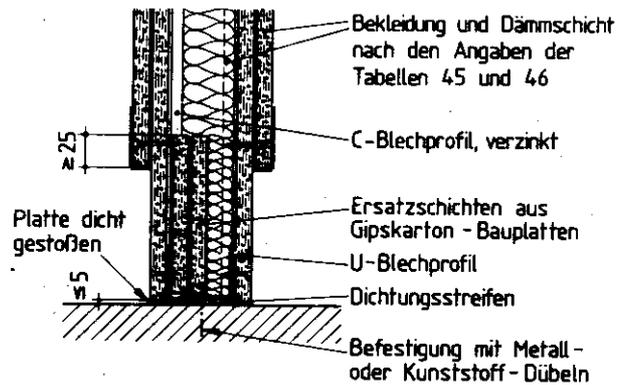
Fußbodenanschluß (Schema, Maße in mm)
